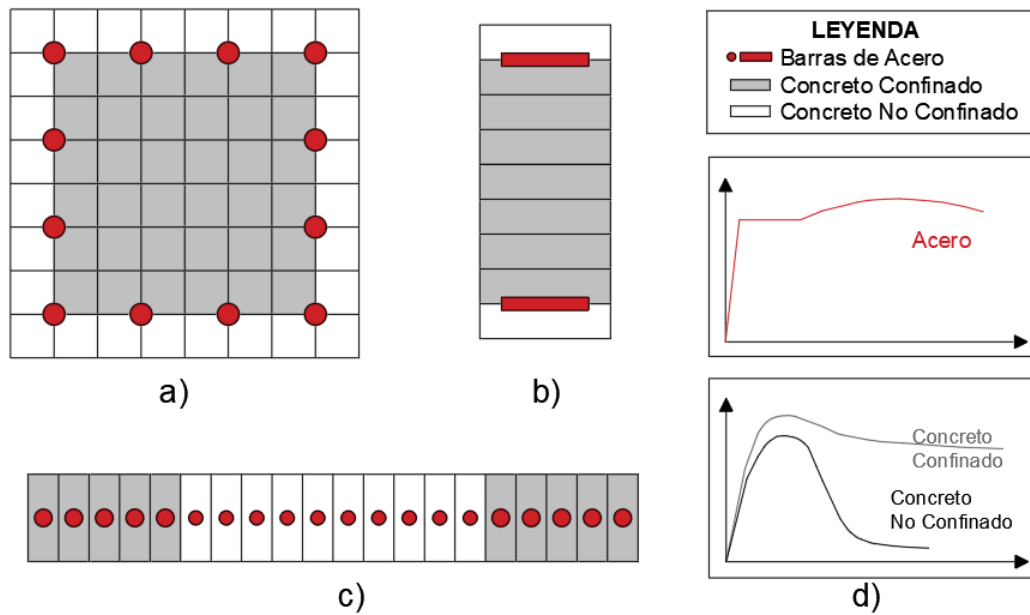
Distribución de Fibras en: a) Columna, b) Viga y c) Muro. El comportamiento de los materiales en las secciones se muestra en d).
